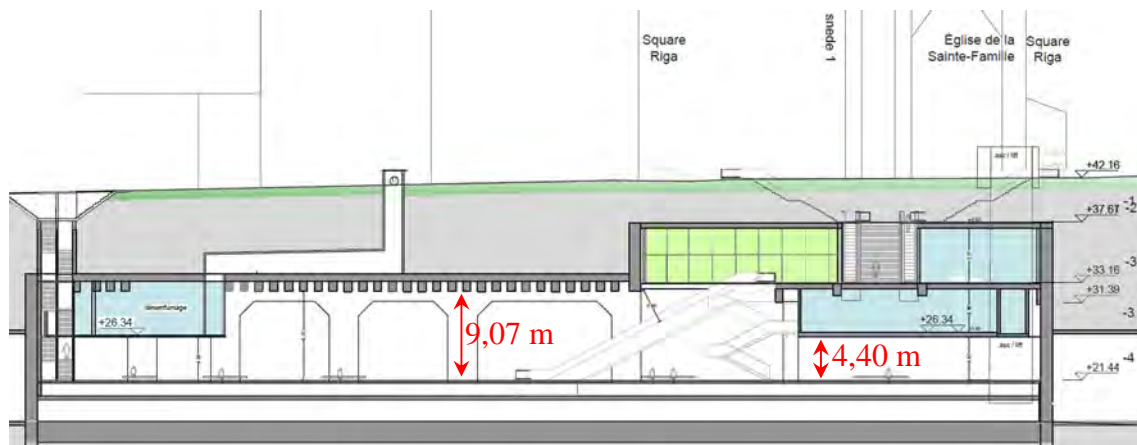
Coupe longitudinale de la station Riga pour l'alternative bitube (BMN, 2020)
